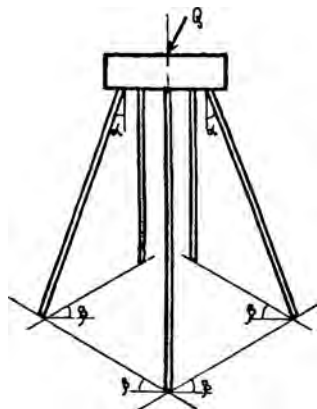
Конструкции забивных свай рационального поперечного сечения,
